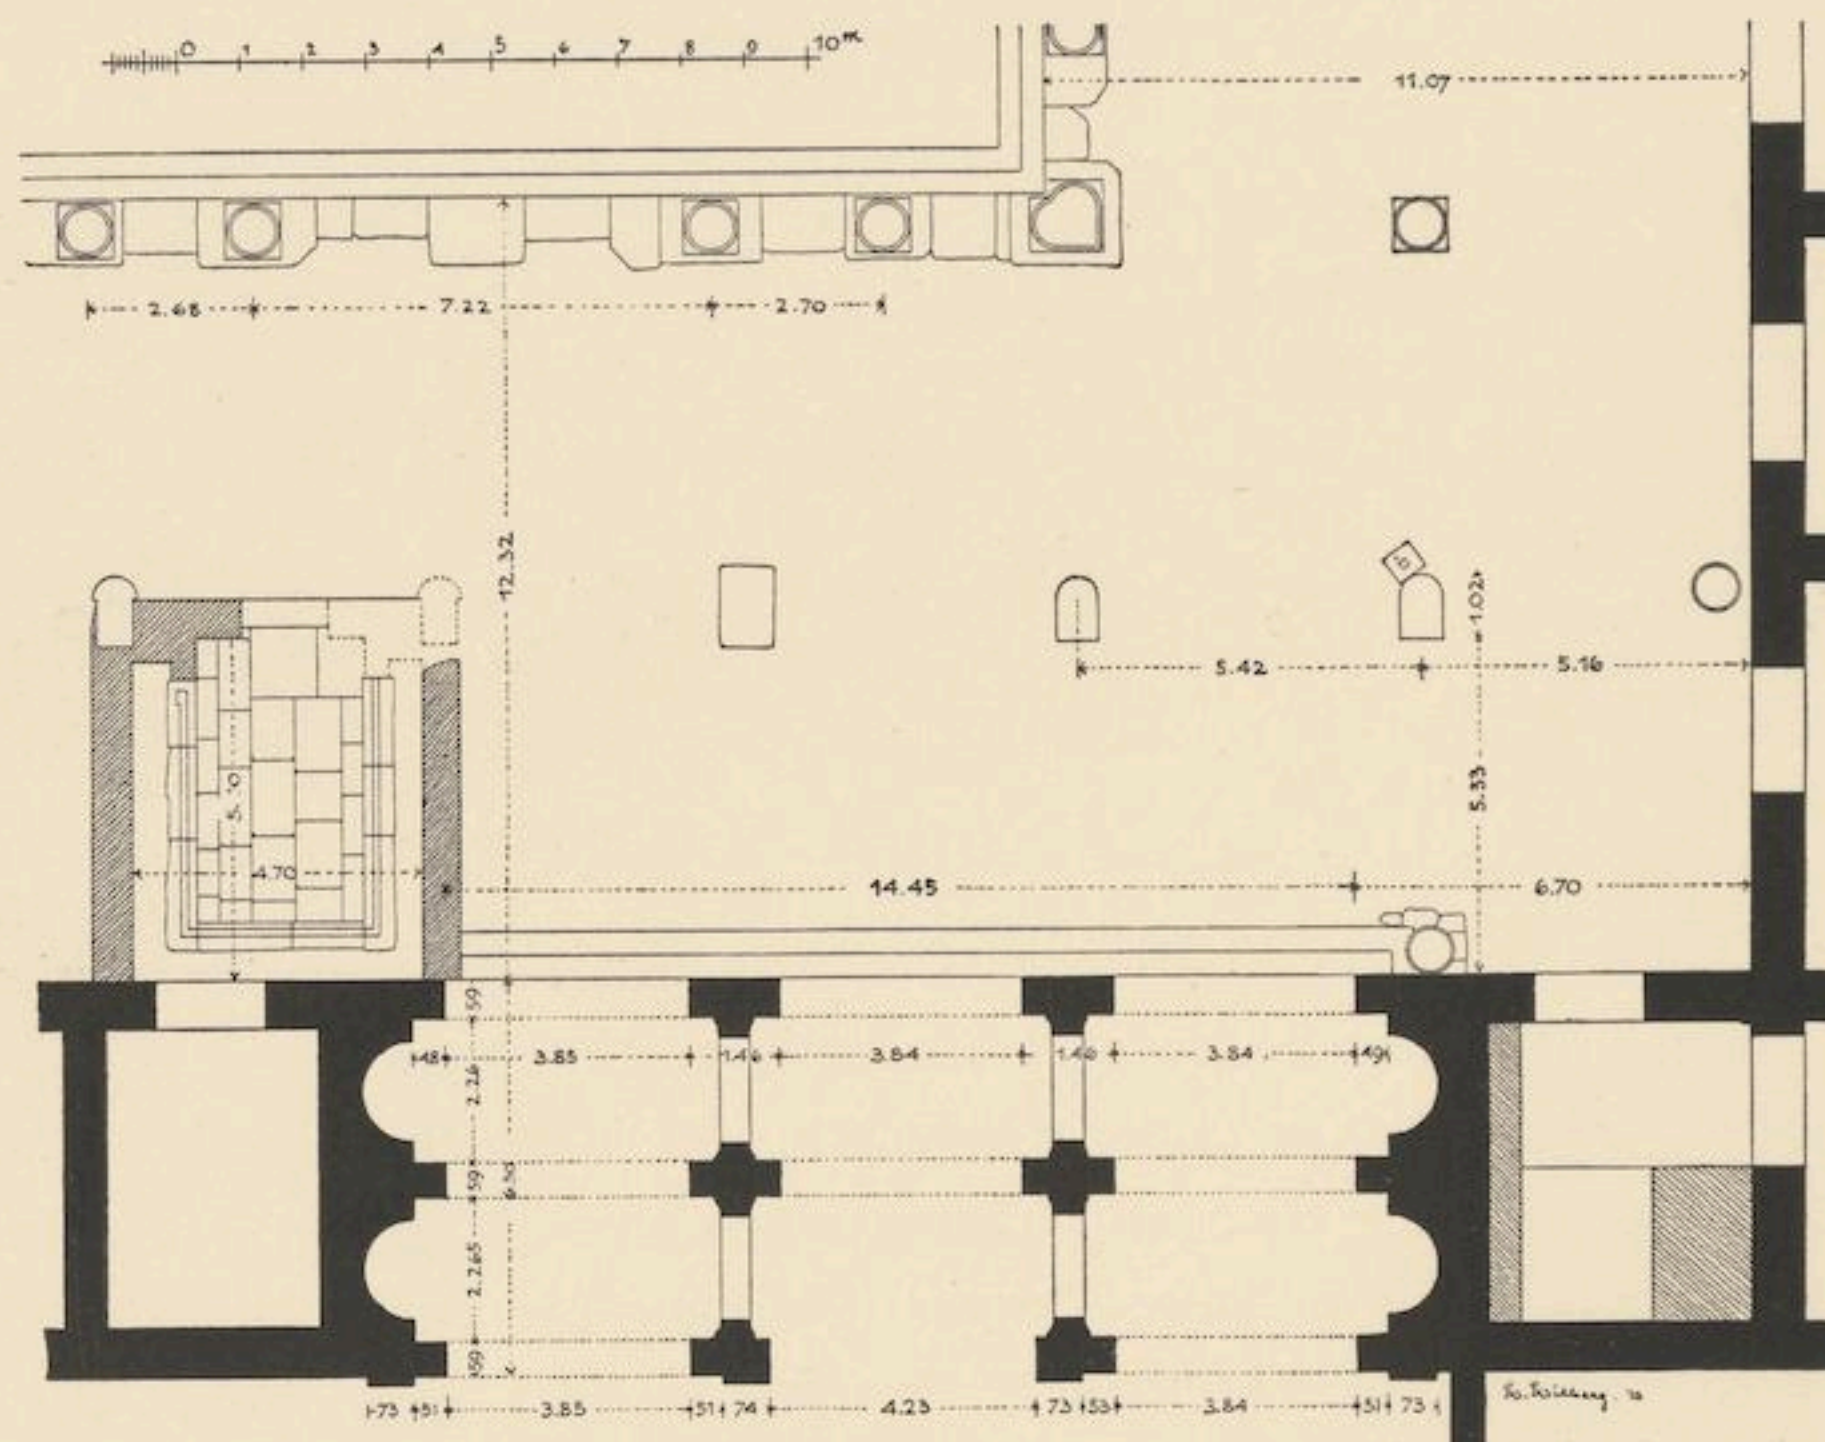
Grundriß des Südtores und der anstoßenden Halle.
